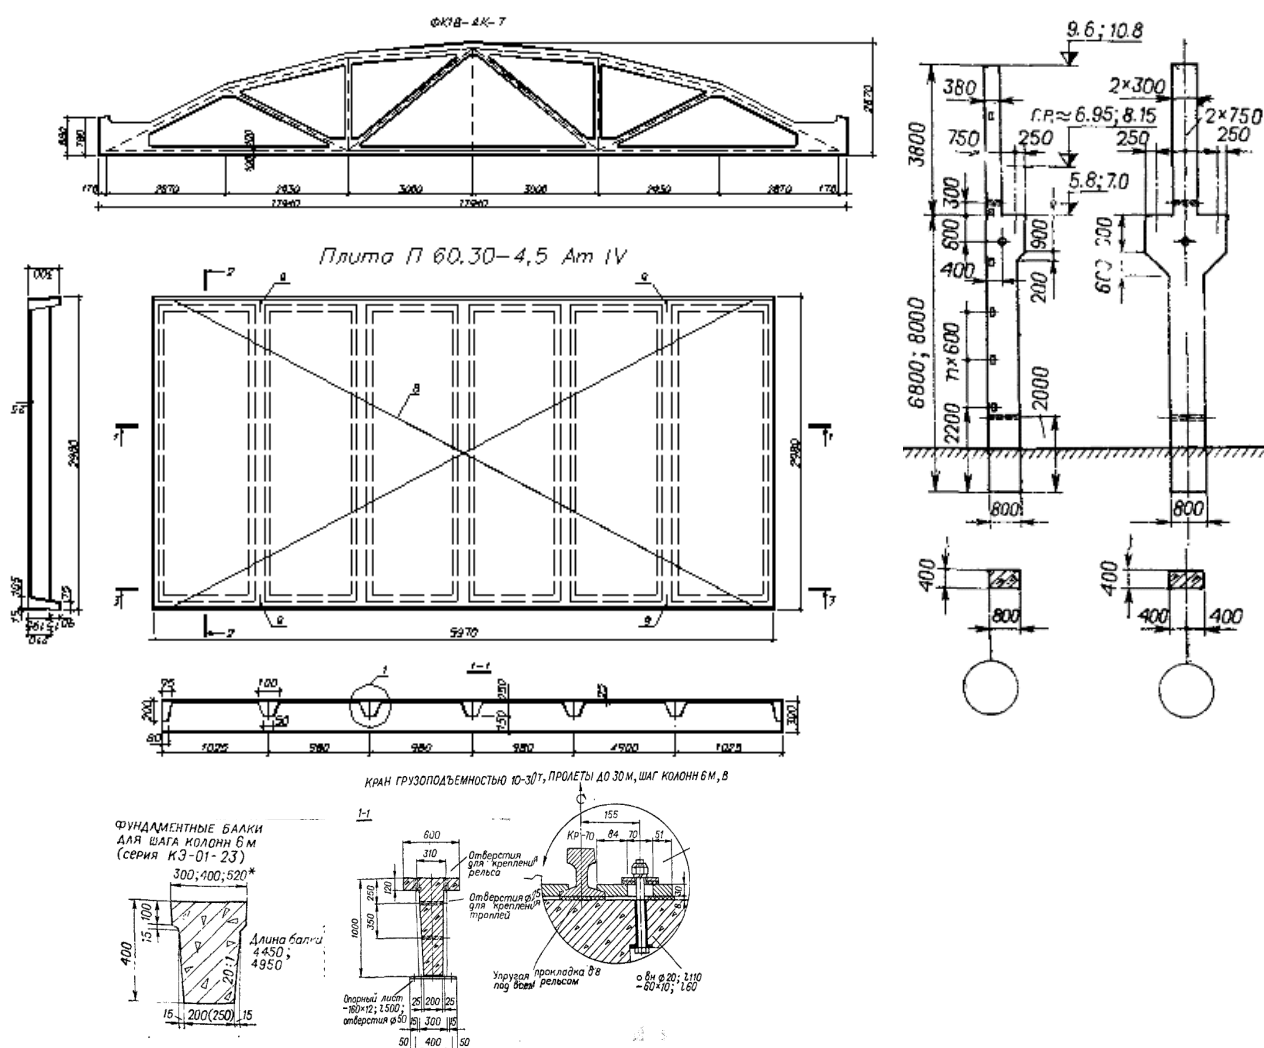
Конструктивні елементи каркасу будівлі
